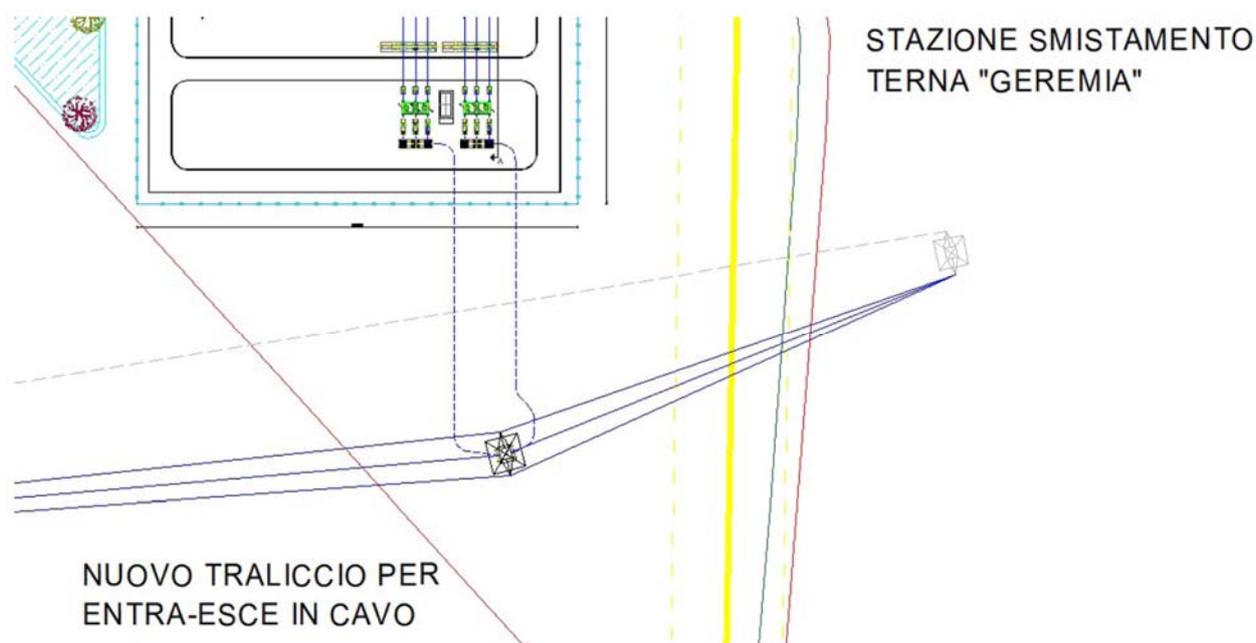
Layout del nuovo collegamento in entra esce della stazione Terna
